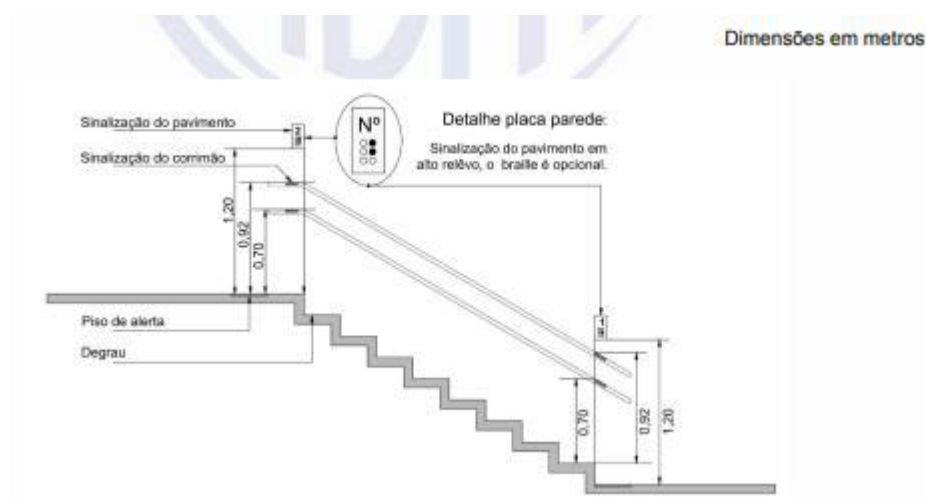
Sinalização de pavimento – vista lateral (Fonte: NBR 9050)
